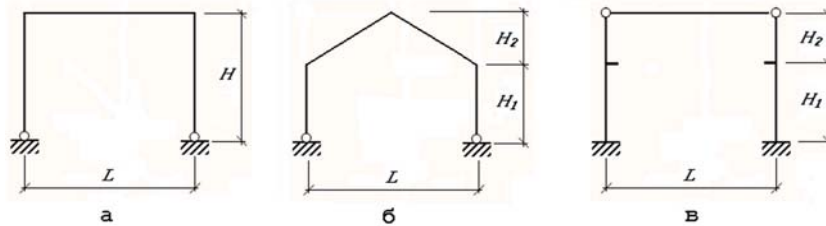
Схеми рам: а, б – з шарнірним спиранням на фундамент (тип I);
